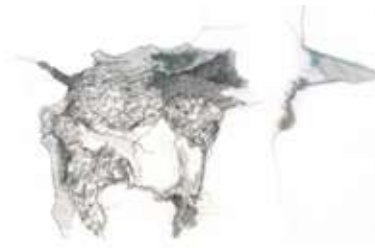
Dettaglio di muro con studio di vegetazione in elevazione e sezione. Foto e disegni di Greta Ruedisueli
